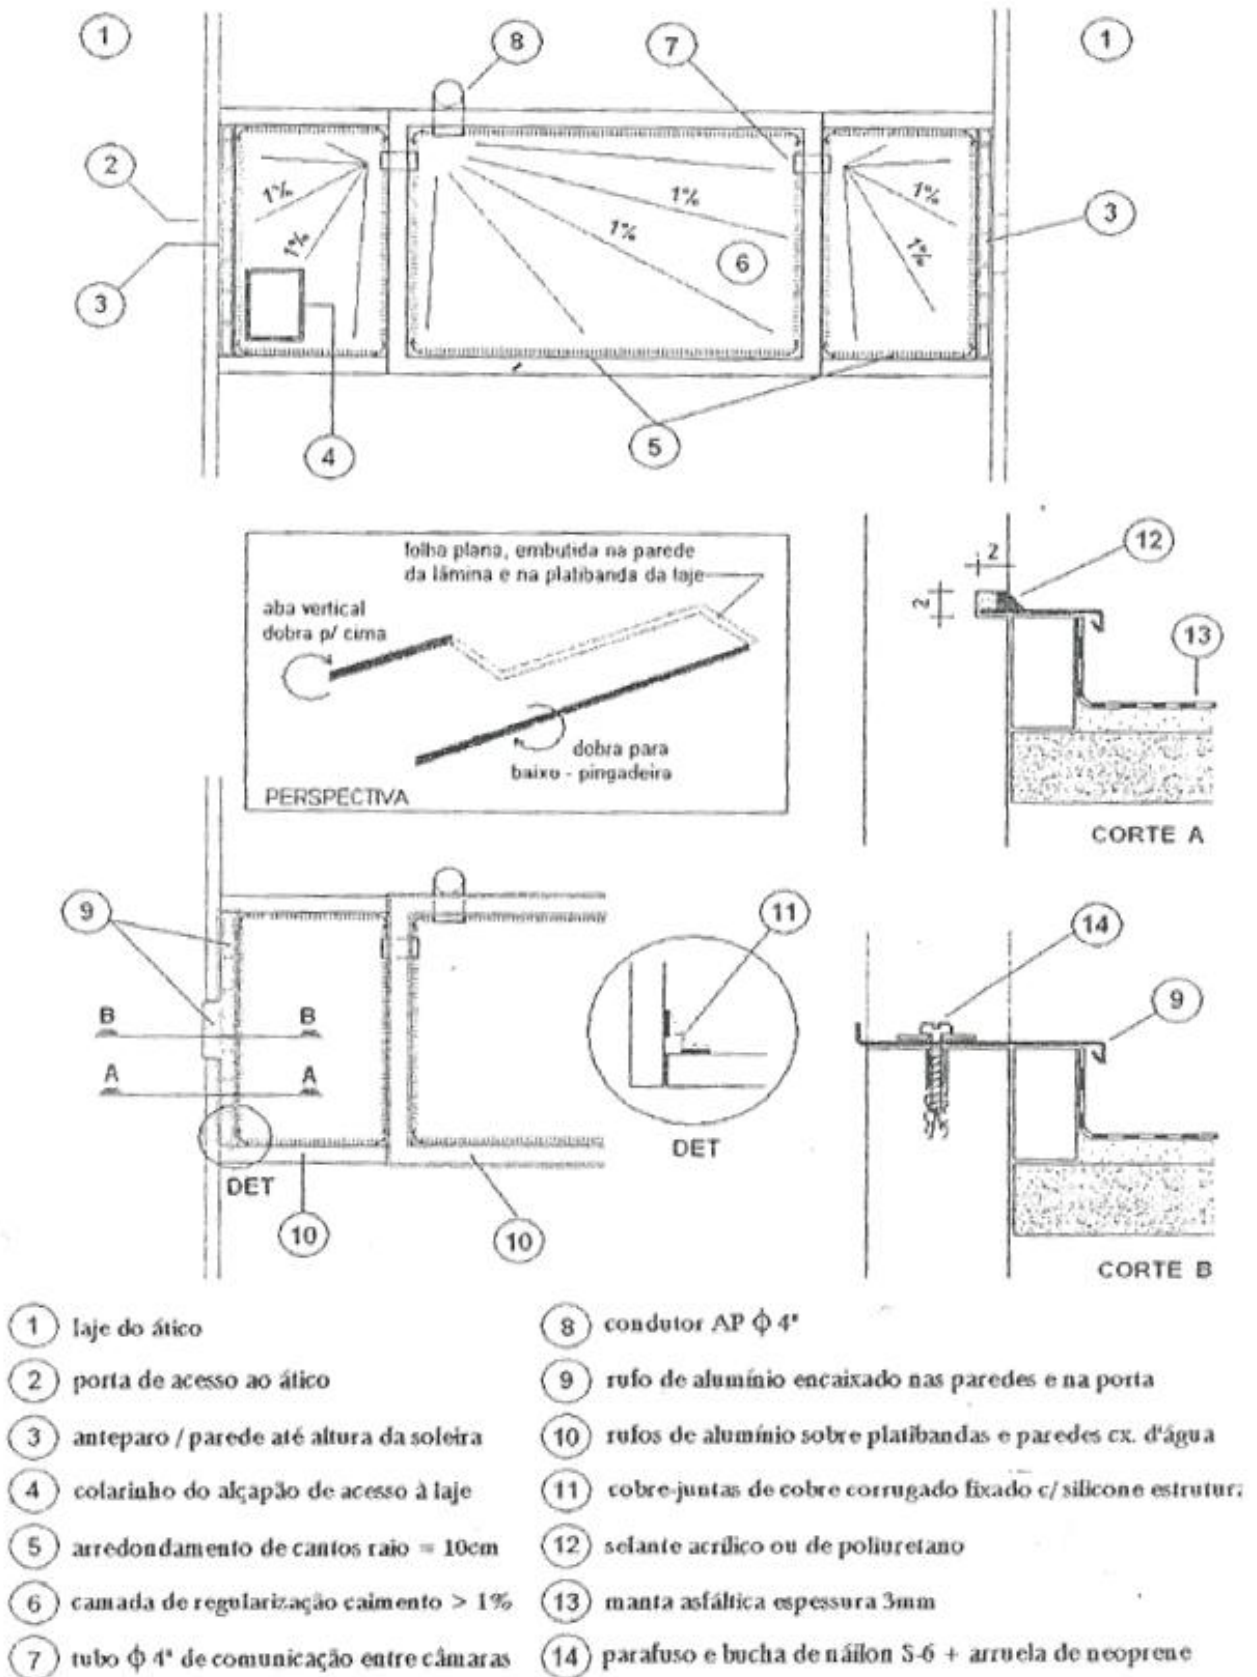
Impermeabilização das lajes de cobertura e instalação de rufos de alumínio (IPT, 2007).
